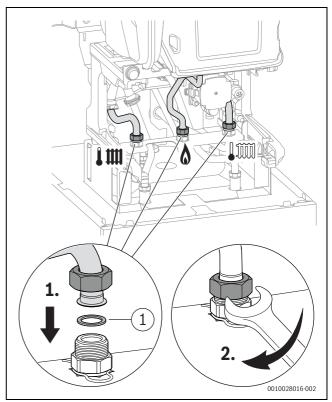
Raccorder le départ chauffage, le tuyau de gaz, le retour chauffage
